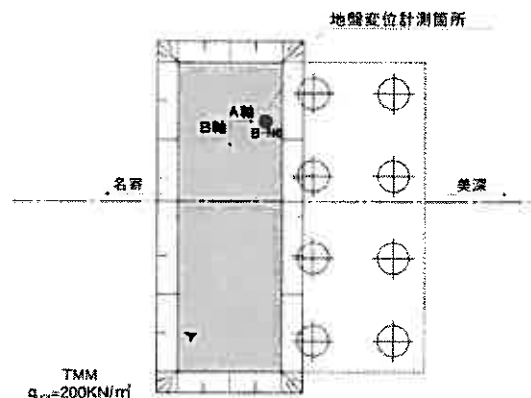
名寄BP橋台背面部(地中変位計設置位置)平面図
